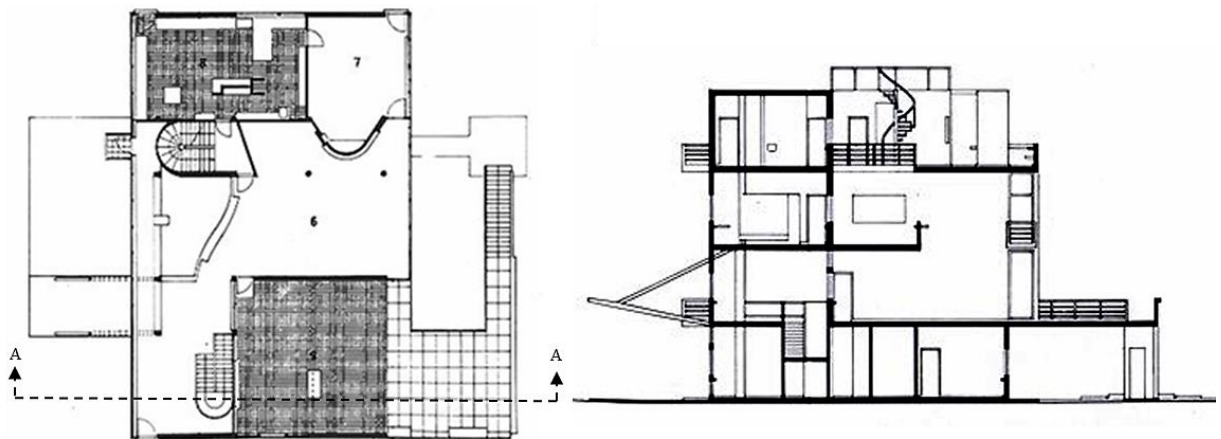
Grundriss des 1.OG (links) und Schnitt A-A (rechts) [27]
